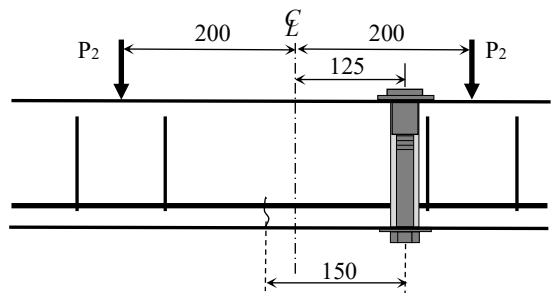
試験体 4 の圧縮力導入位置・ひび割れの位置
